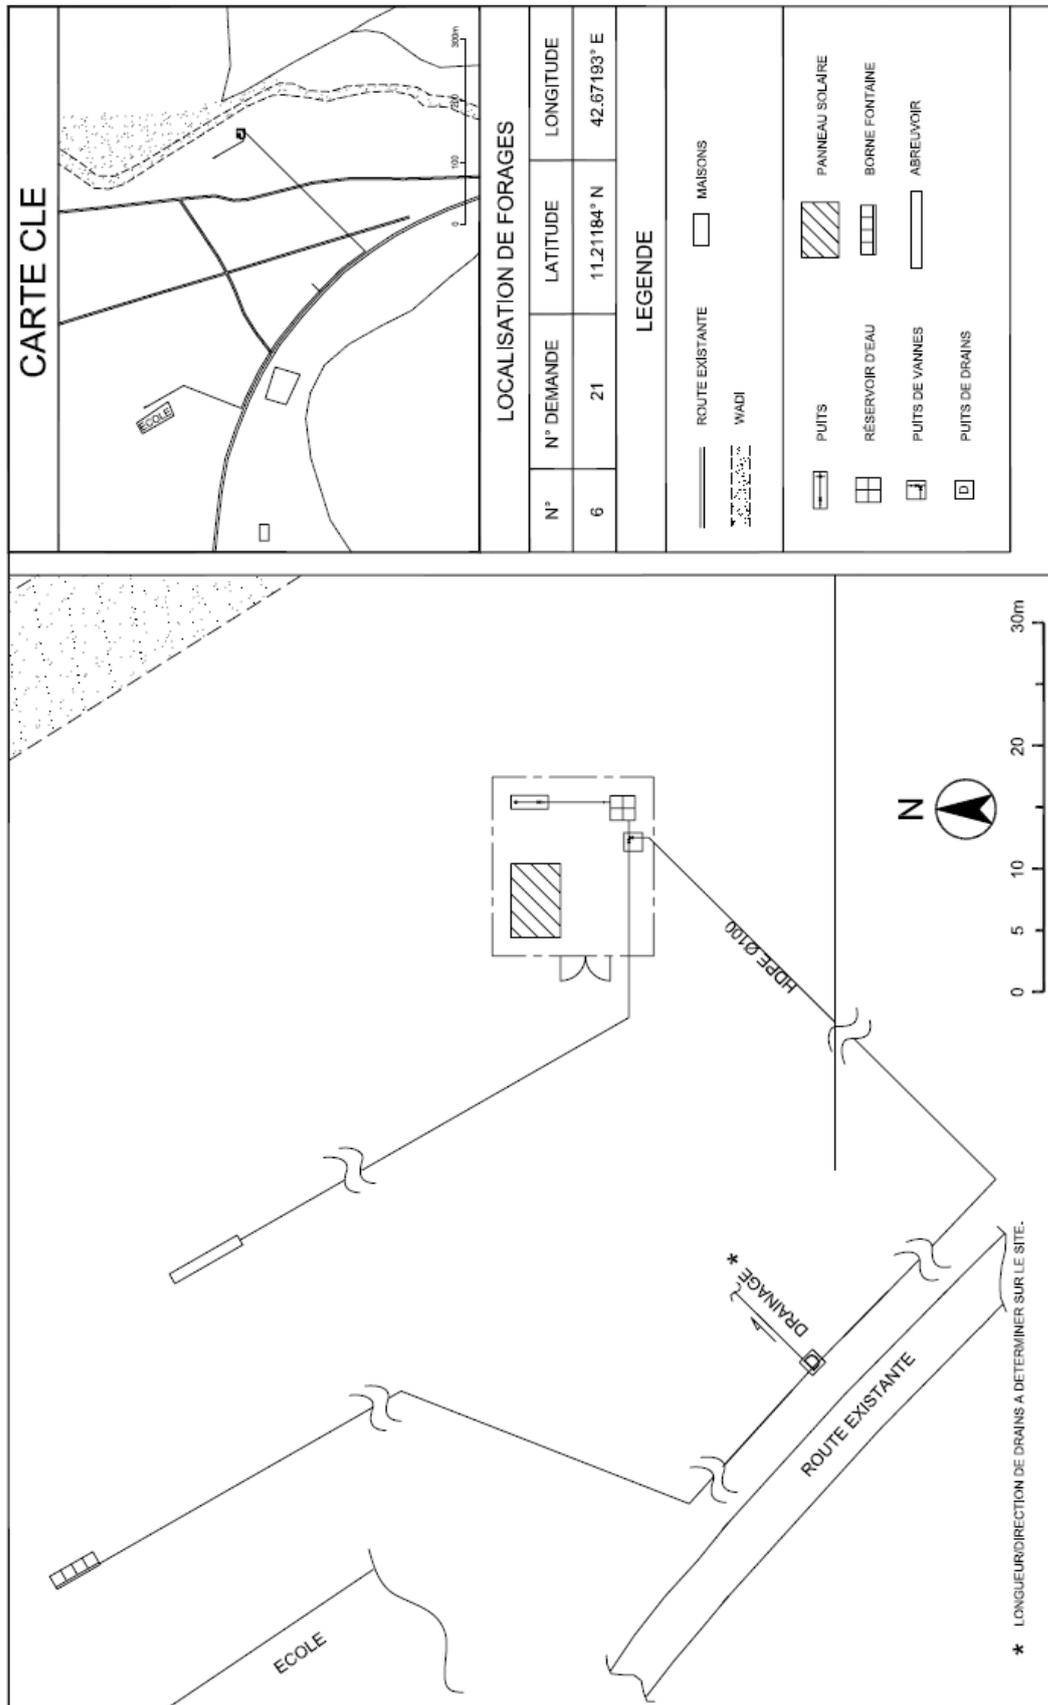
Plan d'implantation des installations (viii) [Hambokta]
